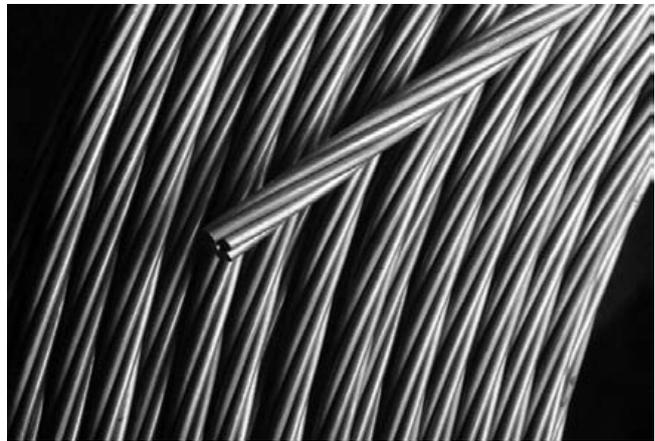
Tipología de refuerzo usado para el pretensado. Torón de acero trefilado.
